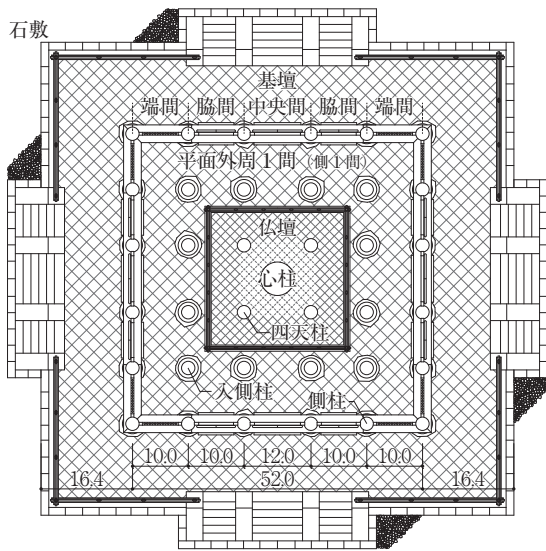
天平塔 (奈文研 2024 案) 初重平面图 1 : 400
